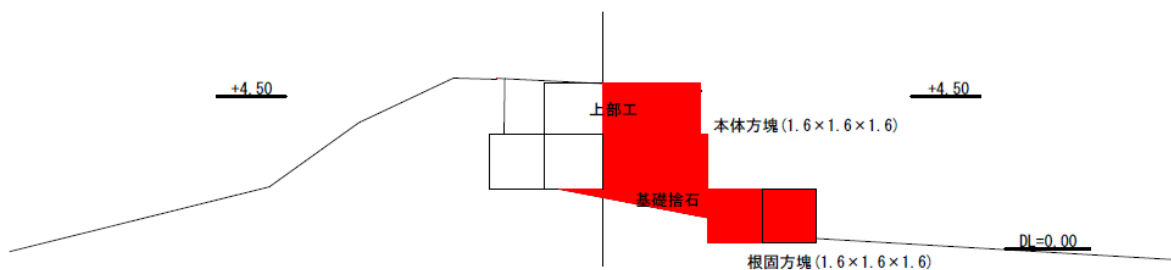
No. 8 南海浜埋立地導流堤の断面図（北側）No. 1（被災後）
